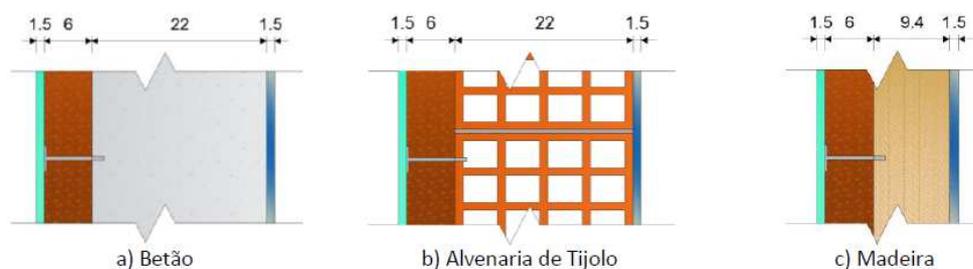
Pormenores construtivos de diferentes soluções – Betão, alvenaria de tijolo e madeira (Prata e Tadeu, 2011)
